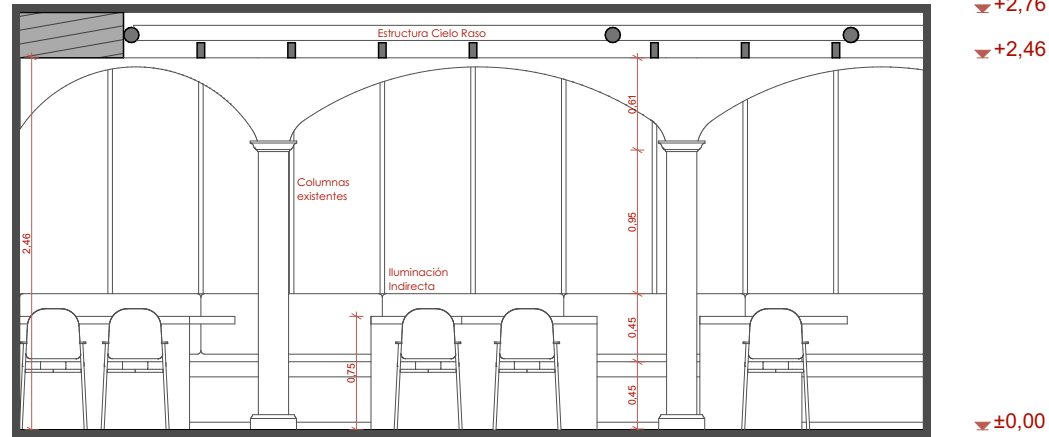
Elevación Interna 1. Fuente: Elaboración Propia
